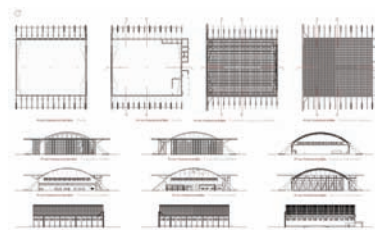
ARGIROFFI G., *Progetto di restauro, piante e sezioni delle aviorimesse
